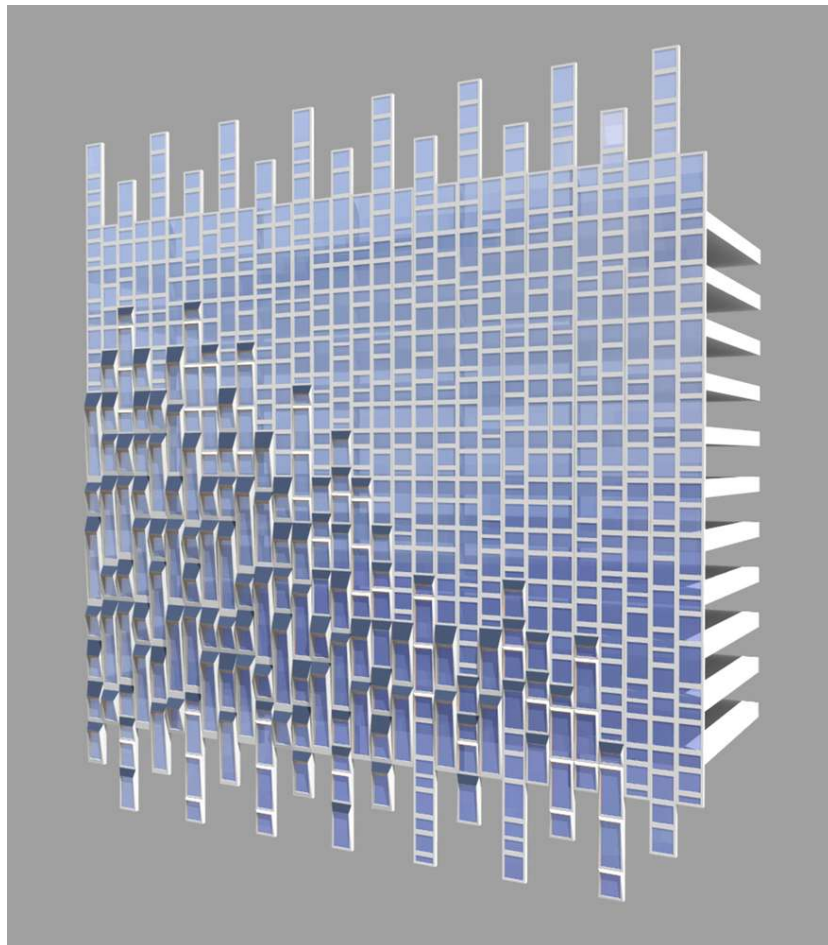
Схема енерго-генеруючих фасадних панелей штаб-квартири Hanwha
